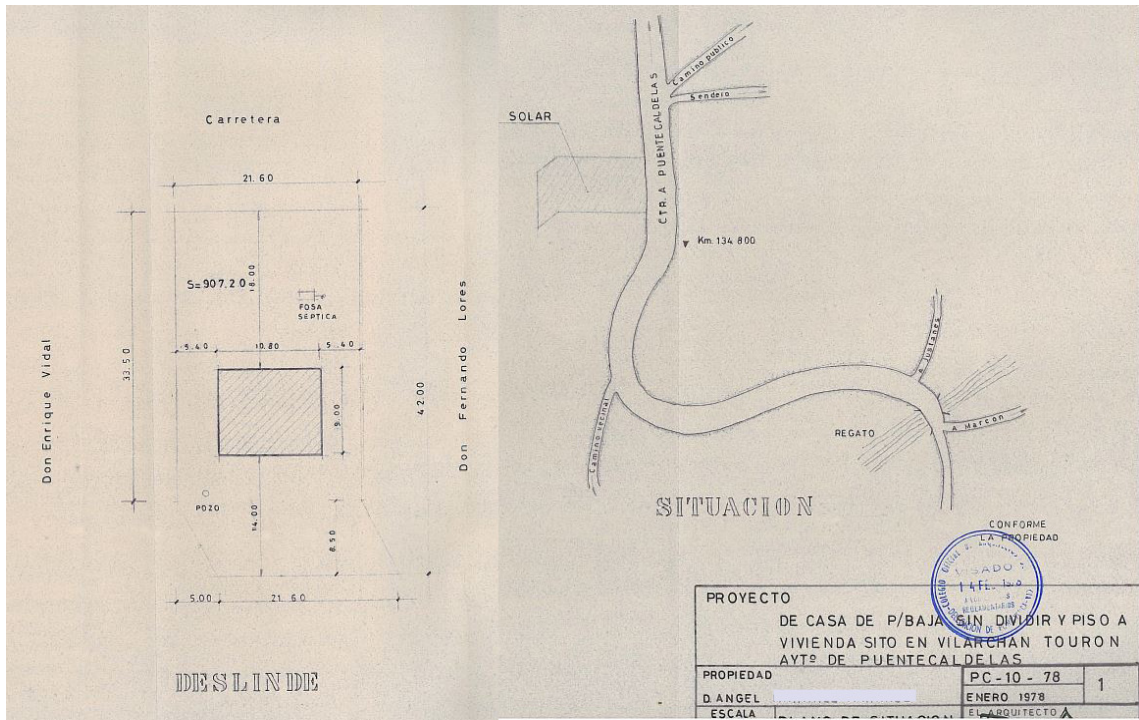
Ejemplo plano de situación y emplazamiento de una vivienda del año 1978. Fuente archivo municipal.
